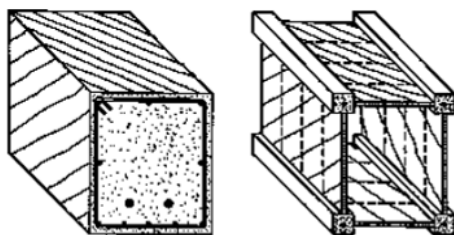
Modelo Corda-Painel para viga de concreto armado
